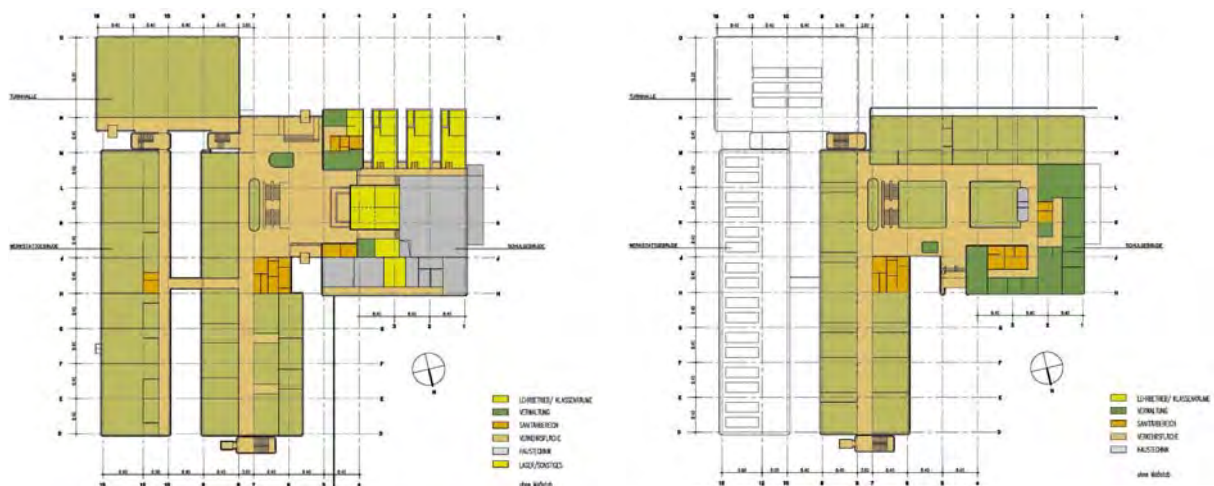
Grundrisse Untergeschoss und Erdgeschoss
